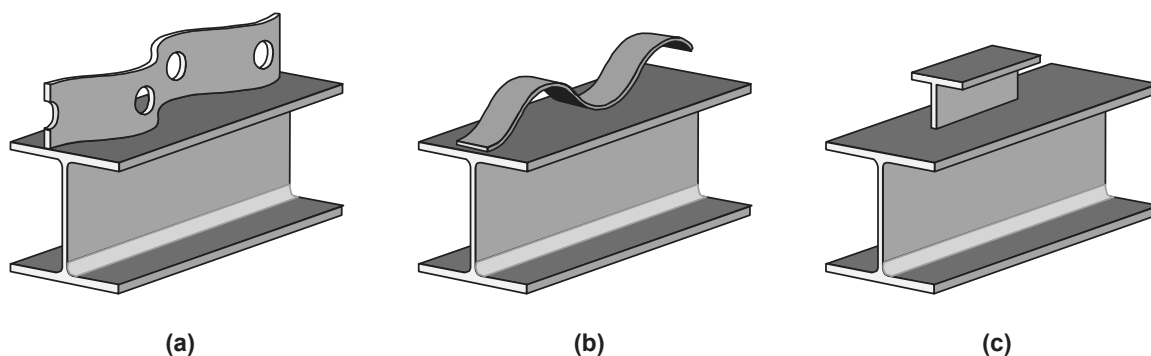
Conectores alternativos ensaiados por GALJAARD e WALRAVEN (2001): a) Perfobond sinuoso; b) tira ondulada; c) perfil T.
